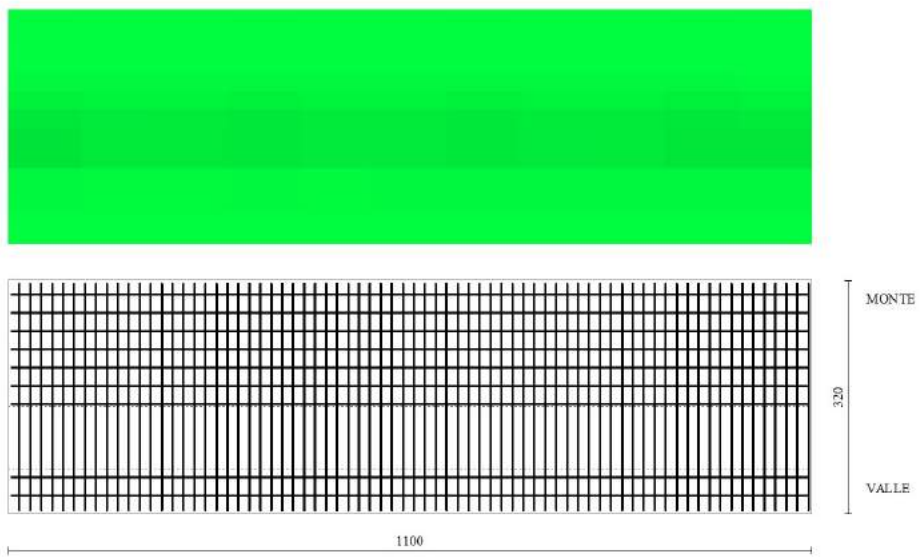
Piastra fondazione dir. Y (Inviluppo)
